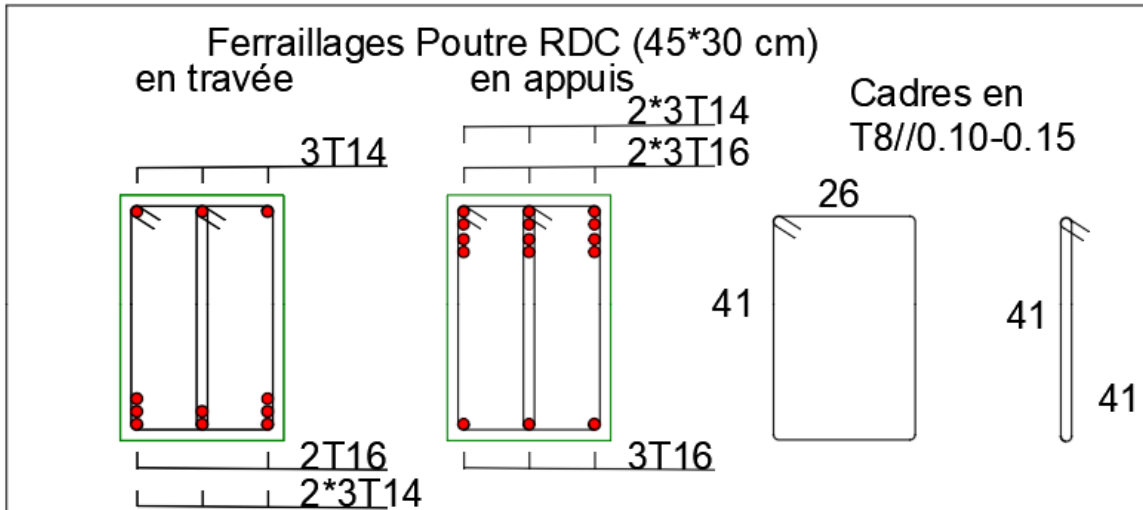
Ferrailages Poutre RDC 45\*30 cm.
